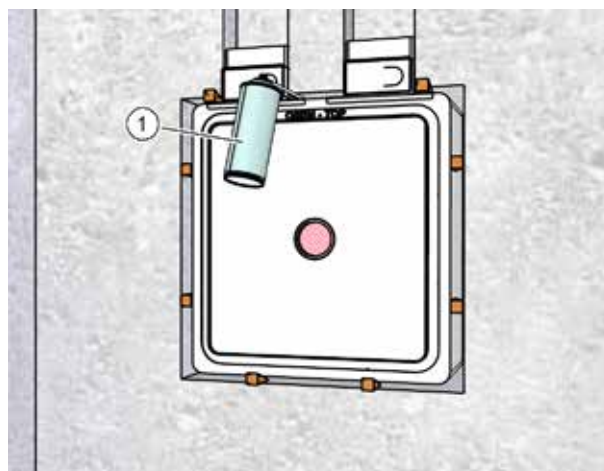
Schiumatura delle cavità intorno alla cassetta a muro
